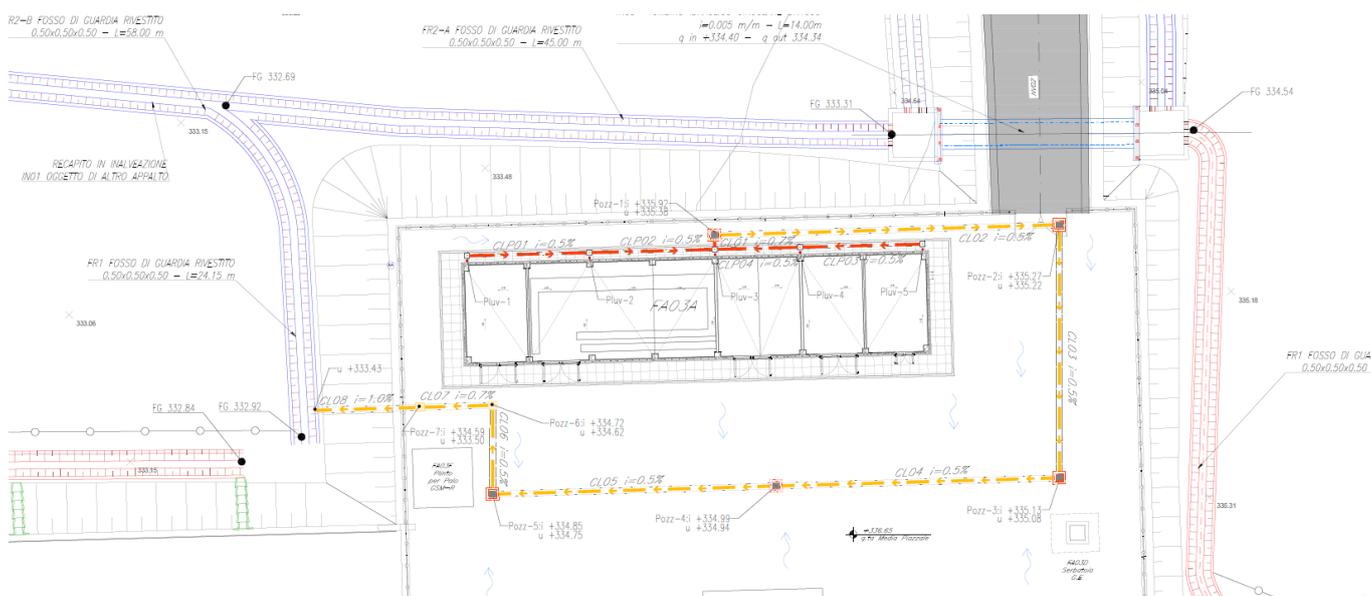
Stralcio planimetrico Rete di drenaggio piazzale RI13
